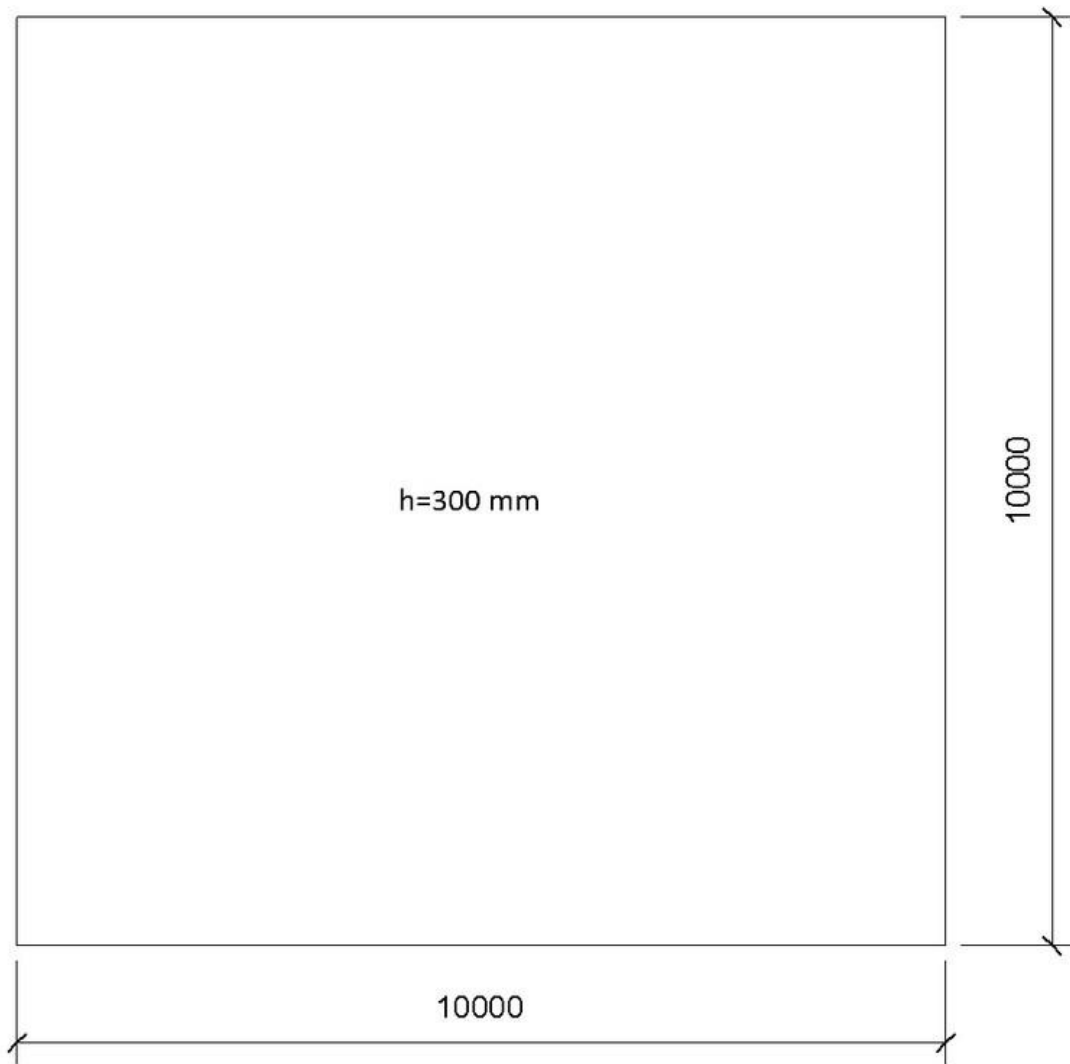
Показана бетонная плита перекрытия размерами 10000x10000 мм, высотой 300 мм для последующего армирования
